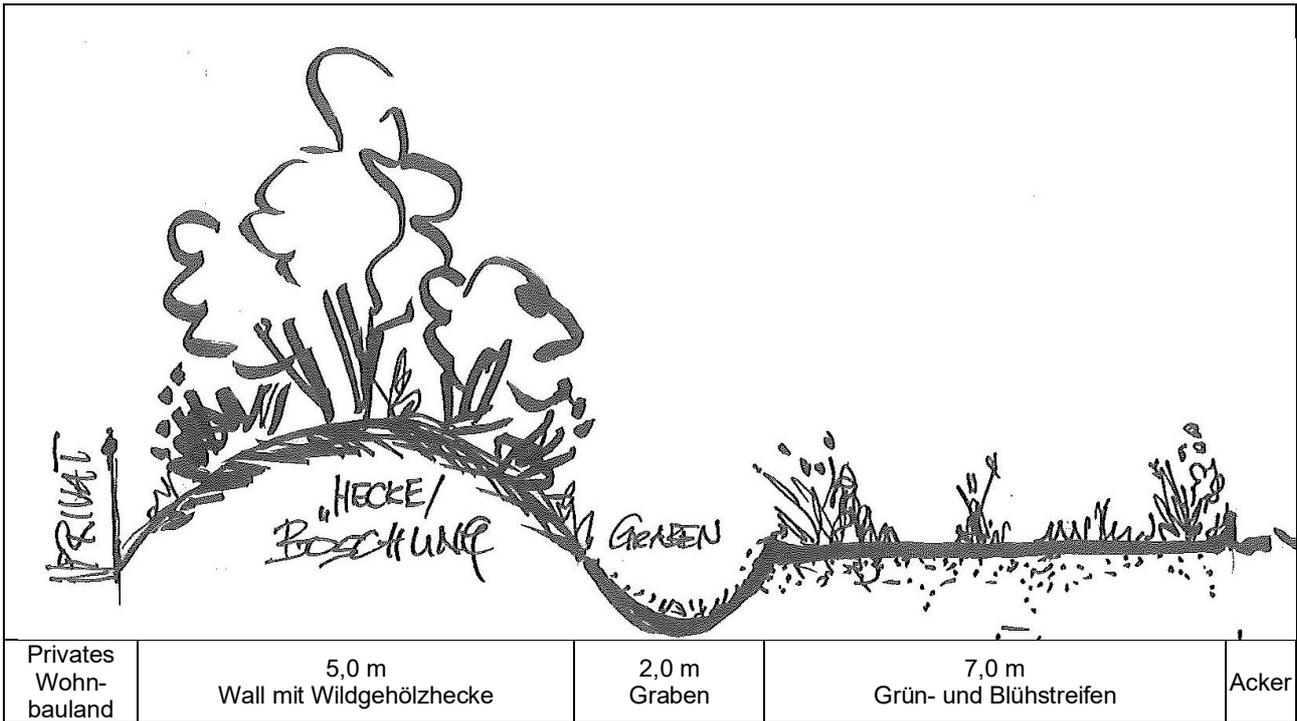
Regelskizze Querschnitt der Wallhecke mit Entwässerungsgraben und Blühstreifen als Übergang und Schutzanlagen gegen wild abfließendes Oberflächenwasser, ohne Maßstab
